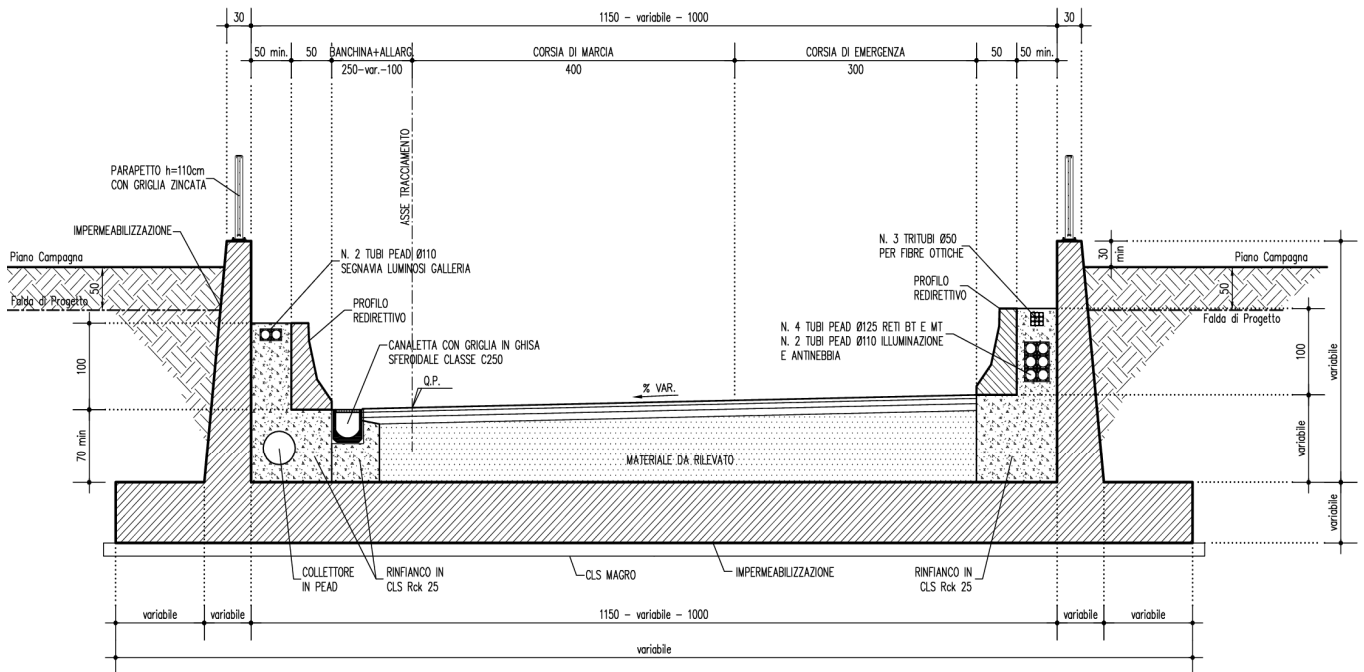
SEZIONE TRASVERSALE TRINCEA DI MURI AD U
